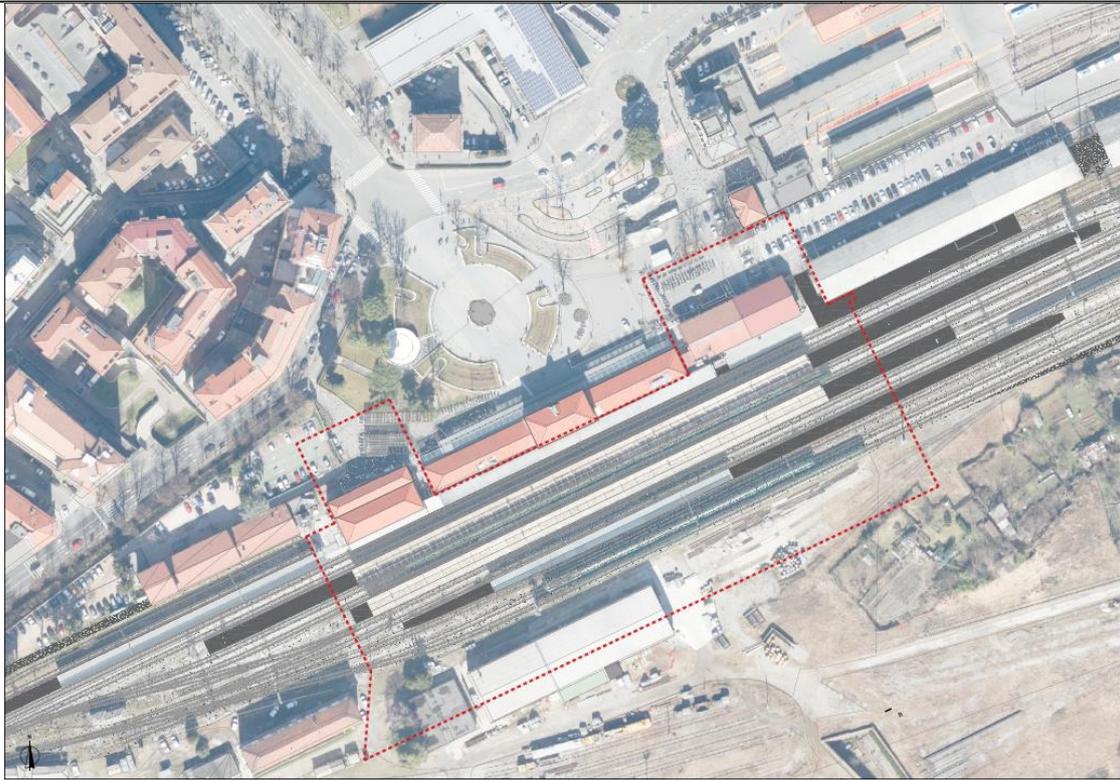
Stazione di Bergamo. Stato di fatto – Planimetria generale
